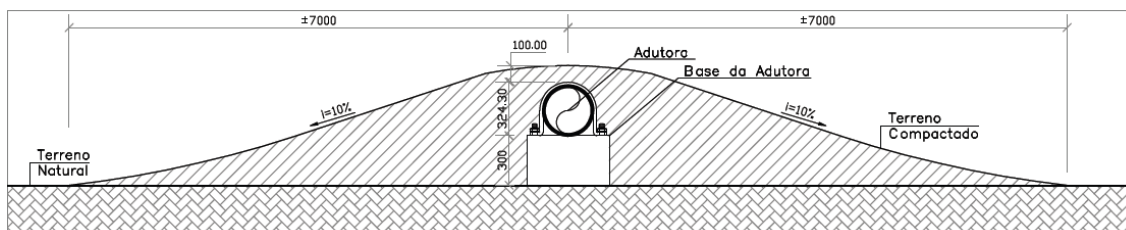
Corte tipo da adutora com solução de passagem de nível (medidas em milímetros).
